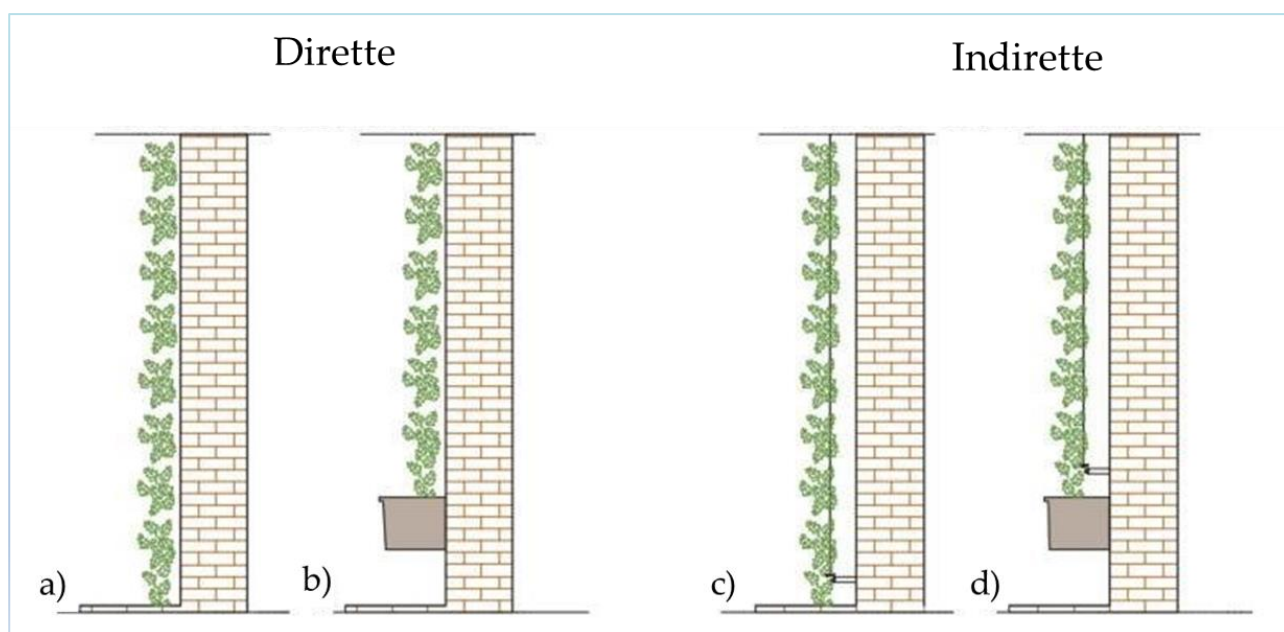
Tipologie di facciate Verdi. a) Facciata verde diretta, con piante in piena terra. b) Facciata verde diretta, con piante in vaso. c) Facciata verde indiretta, con piante in piena terra. d) Facciata verde indiretta, con piante in vaso.
